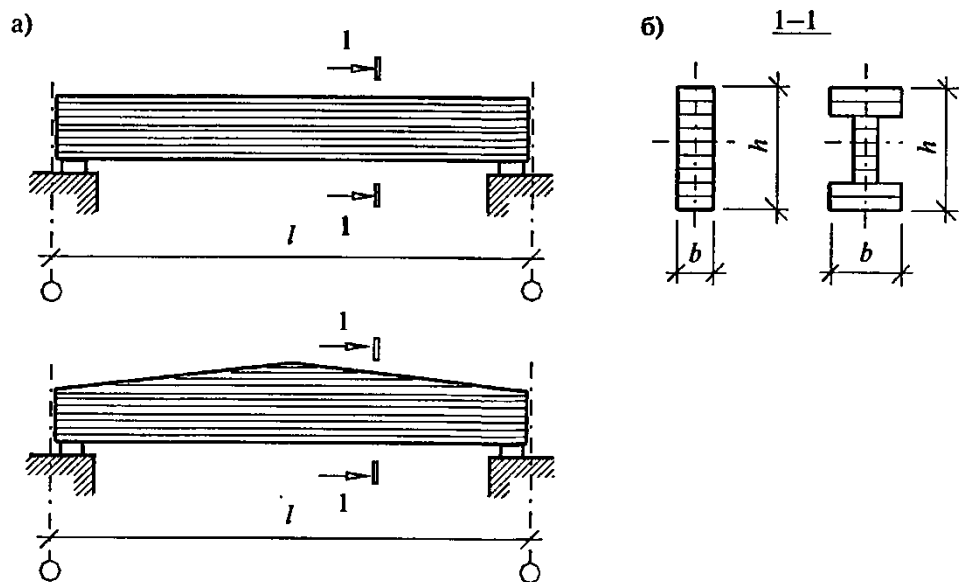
Клееные балки: а) типы клееных балок из досок; б) возможные сечения балок (прямоугольное, двутавровое)
